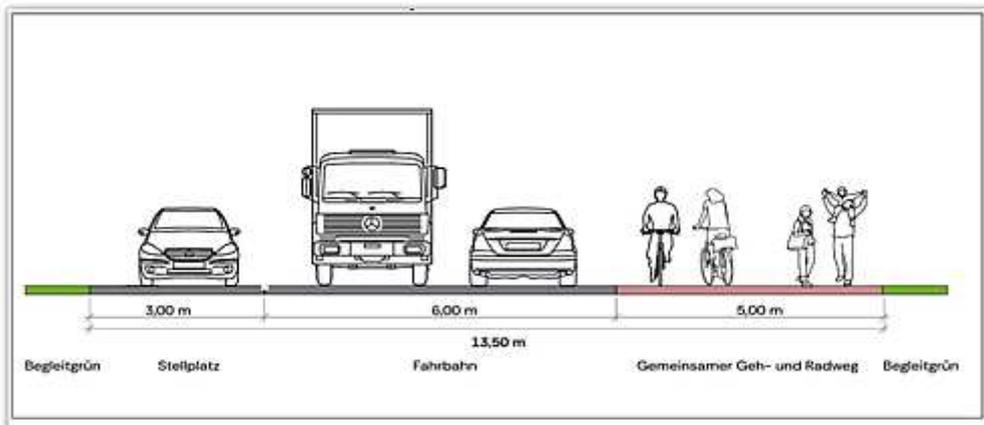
Querschnittsentwurf Hauptstraße Höhe der Ein- und Ausfahrt des Plangebiets
